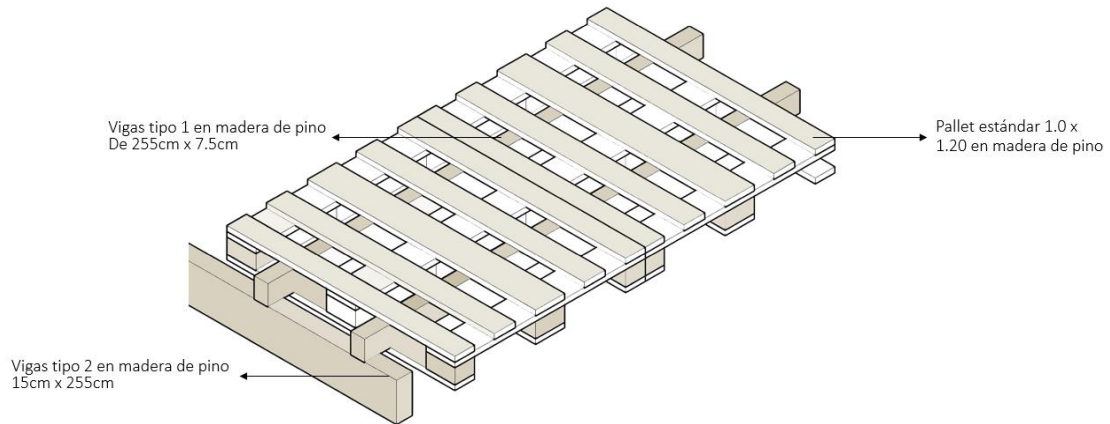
Detalle vigas de entrepiso y pallet de entrepiso
